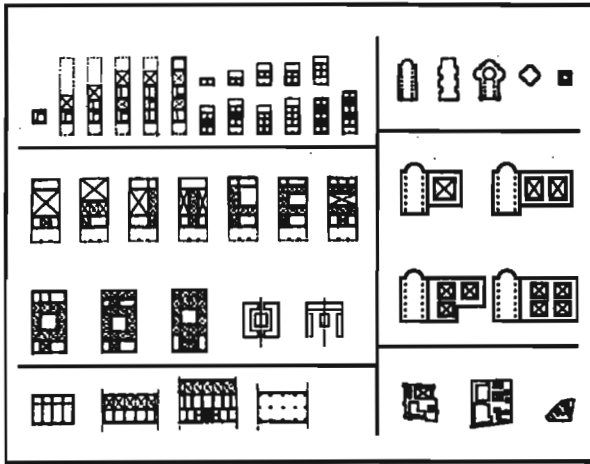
Esquemas utilizados para los levantamientos tipológicos del Plan de Bolonia (Cervellati, 1981:124).
